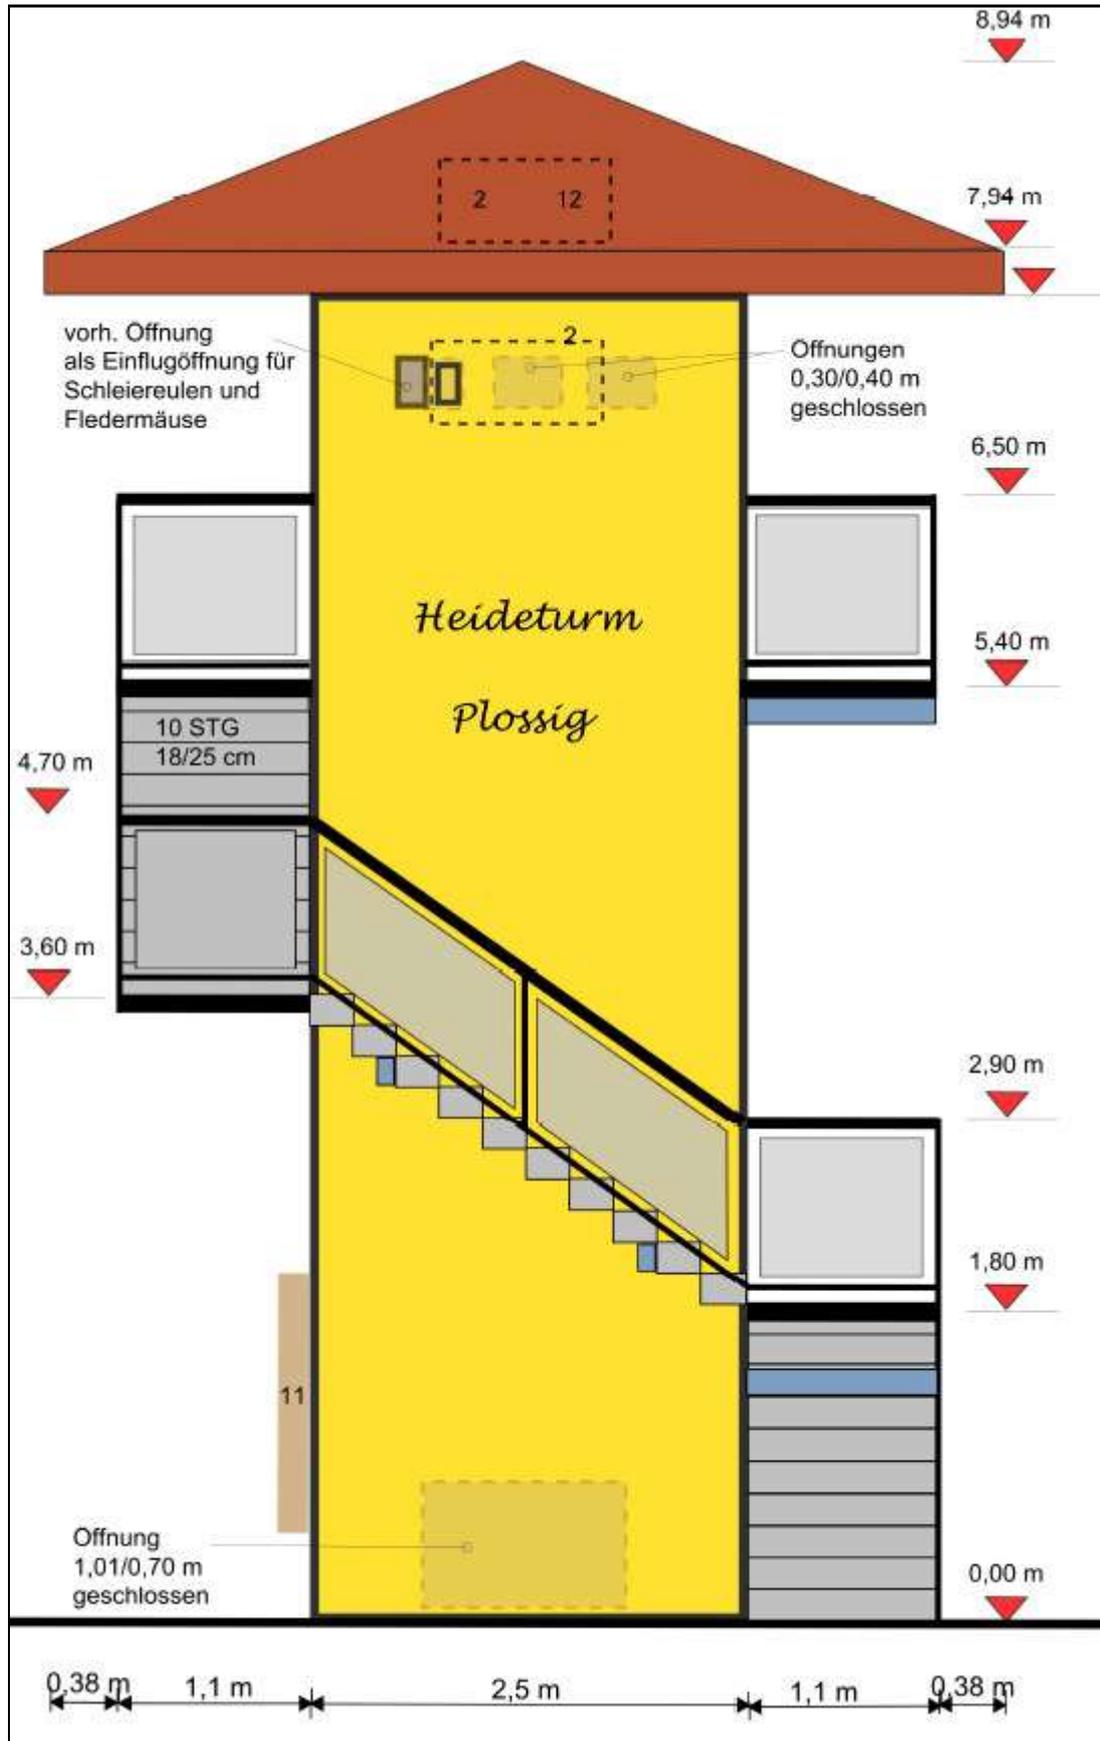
Beispielansicht Turm Nordost - Planung mit Dach und Außentreppe
